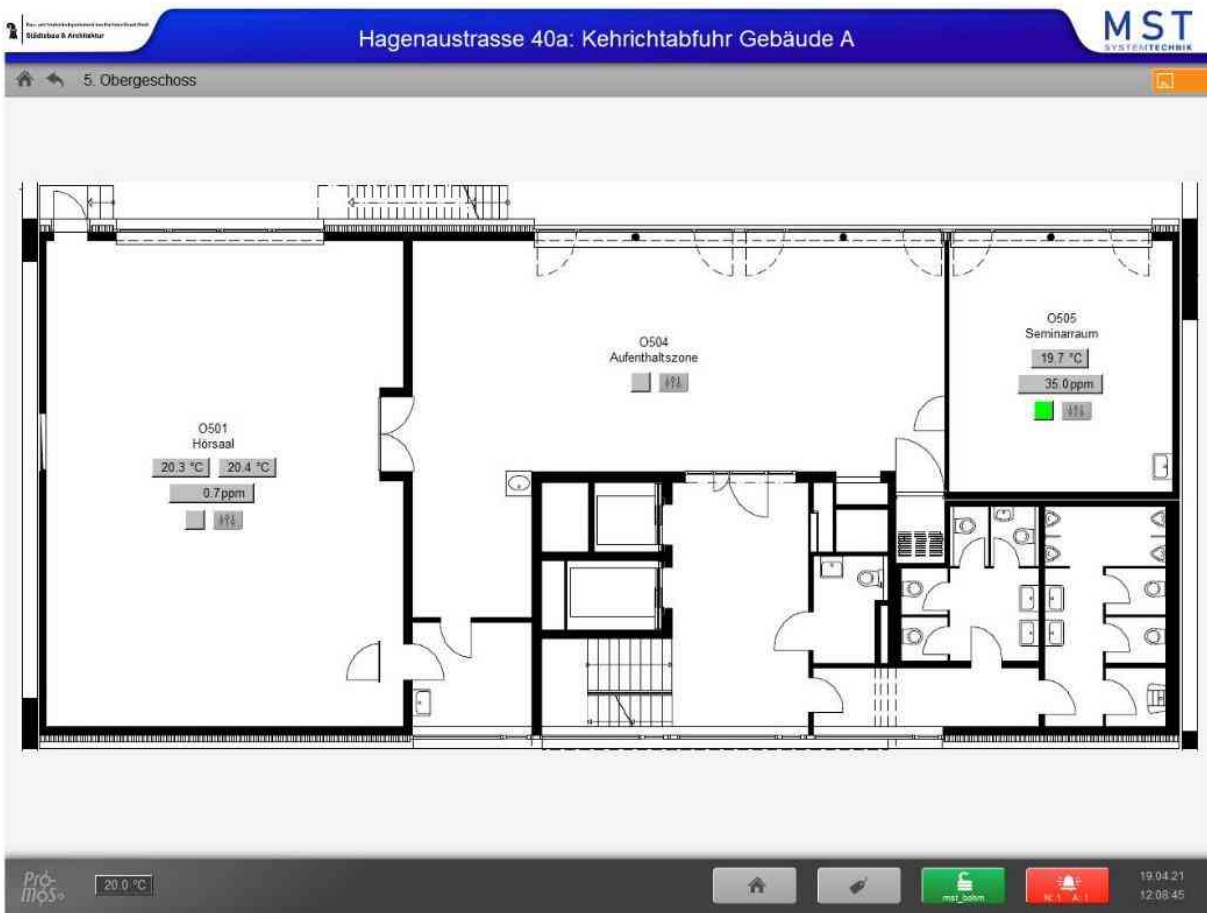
Beispiel Visualisierung Raumautomation in Grundrissplan
